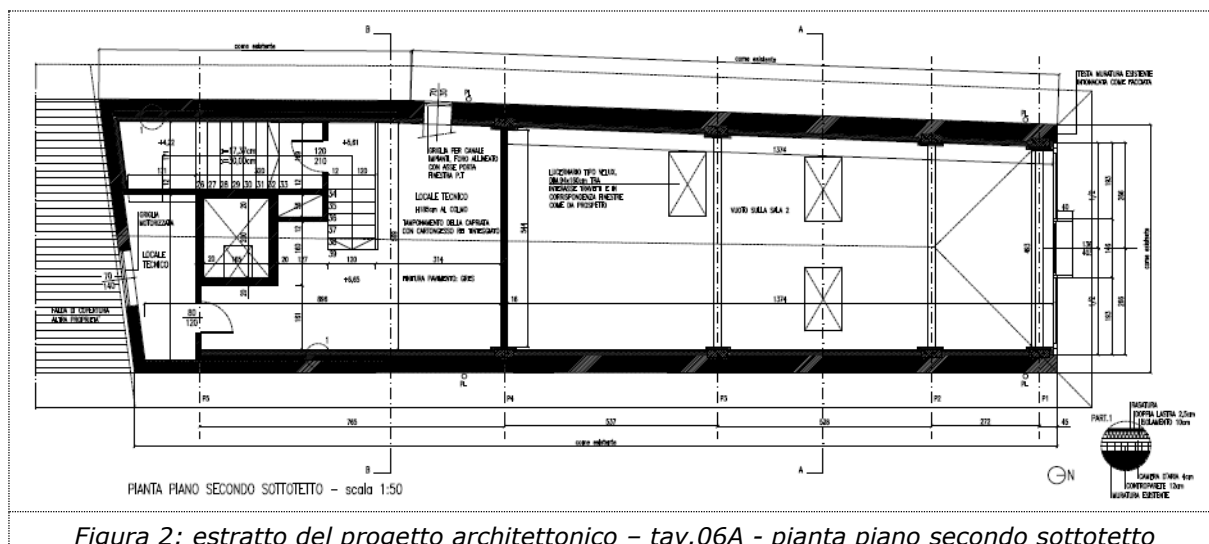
estratto del progetto architettonico – tav.06A – pianta piano secondo sottotetto
